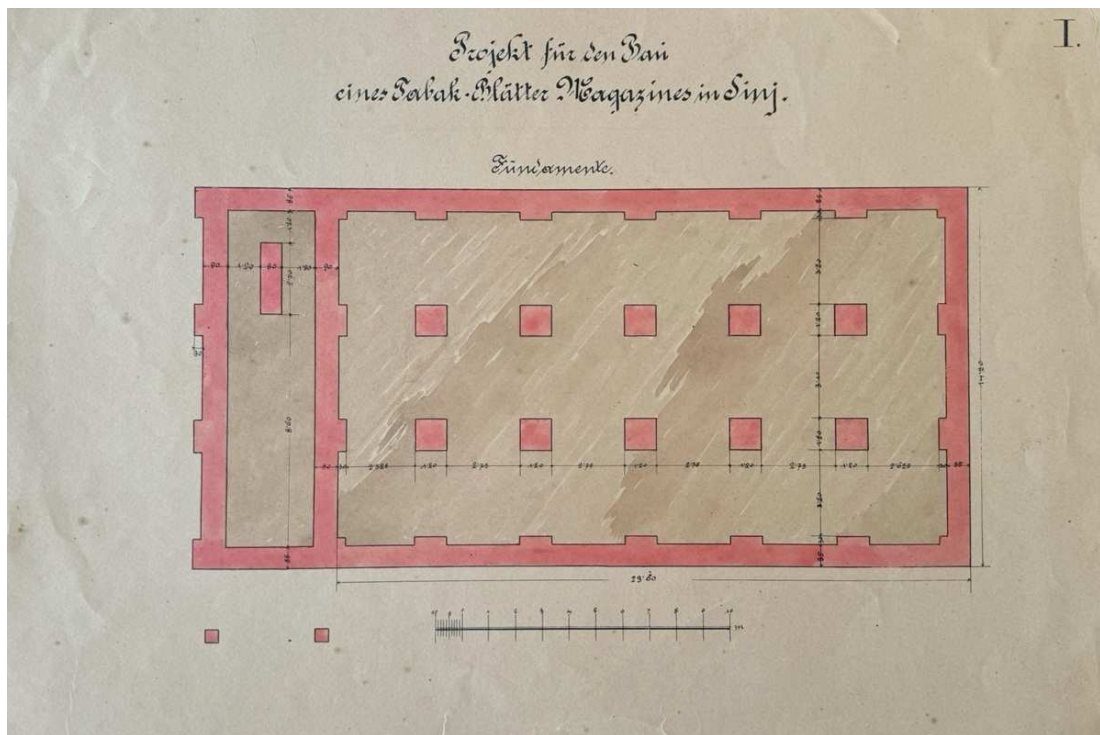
Projekt für den Bau eines Tabak-Blätter-Magazines in Sinj, Grundriss des Fundaments.
